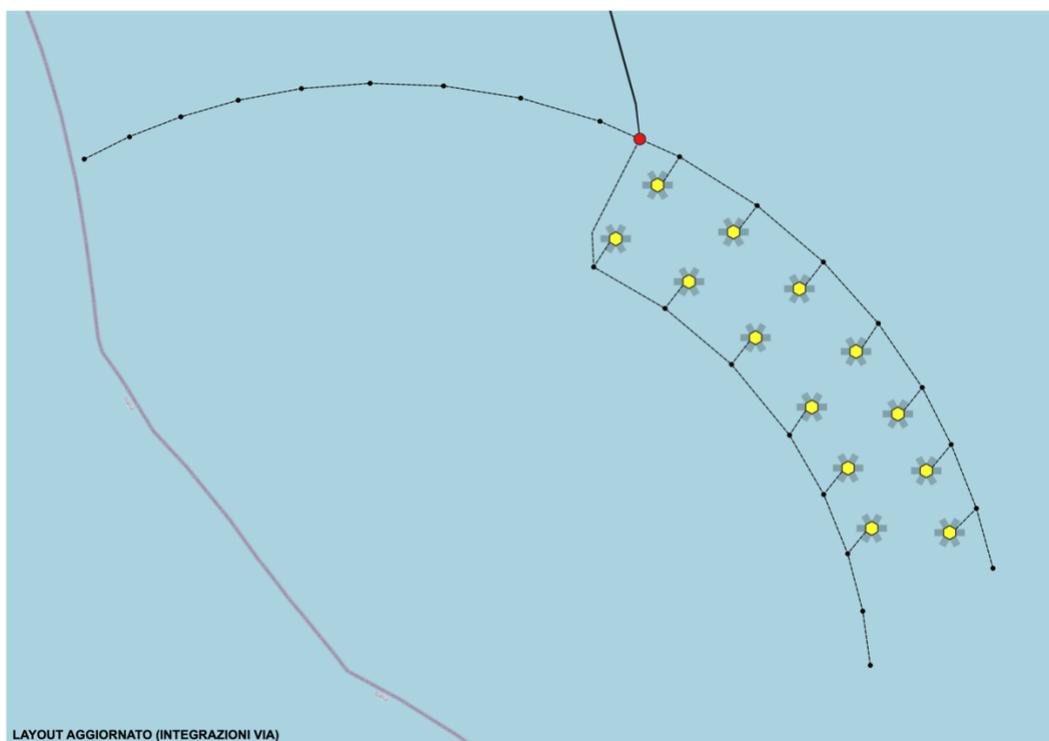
Planimetria del layout aggiornato in seguito alle richieste di integrazioni
